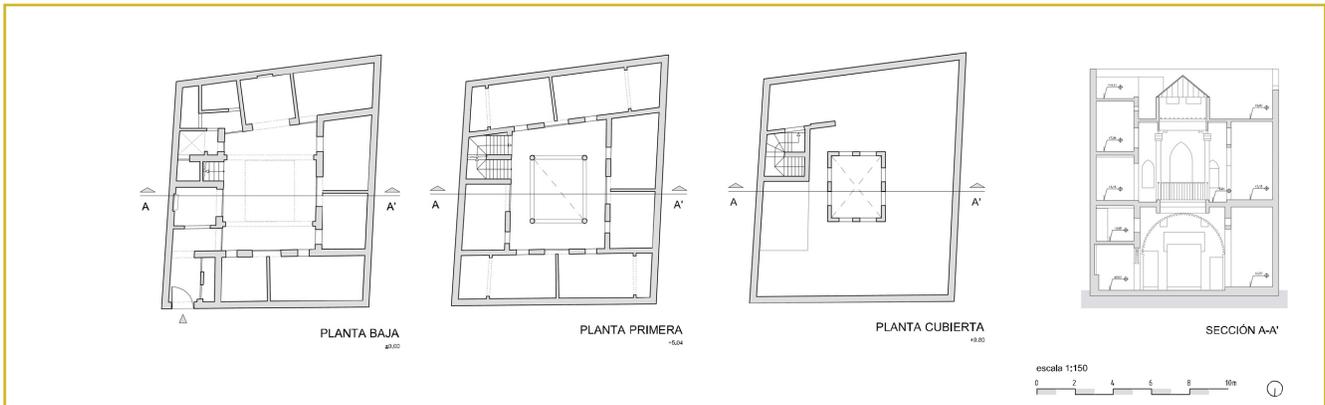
Plantas y corte de dar Hotel Arabic (fuente: Los autores).
